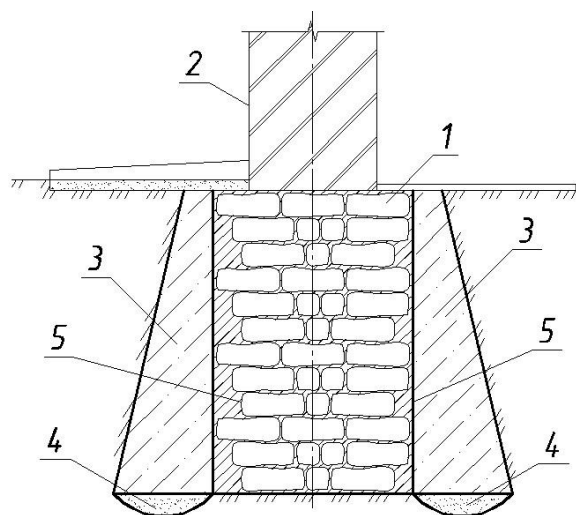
Посилення опорної площі улаштуванням приливів з бетону: 1 – посилюваний фундамент; 2 – цегляна стіна; 3 – приливи з бетону; 4 – зони ущільненого ґрунту; 5 – поверхня посилюваного фундаменту
